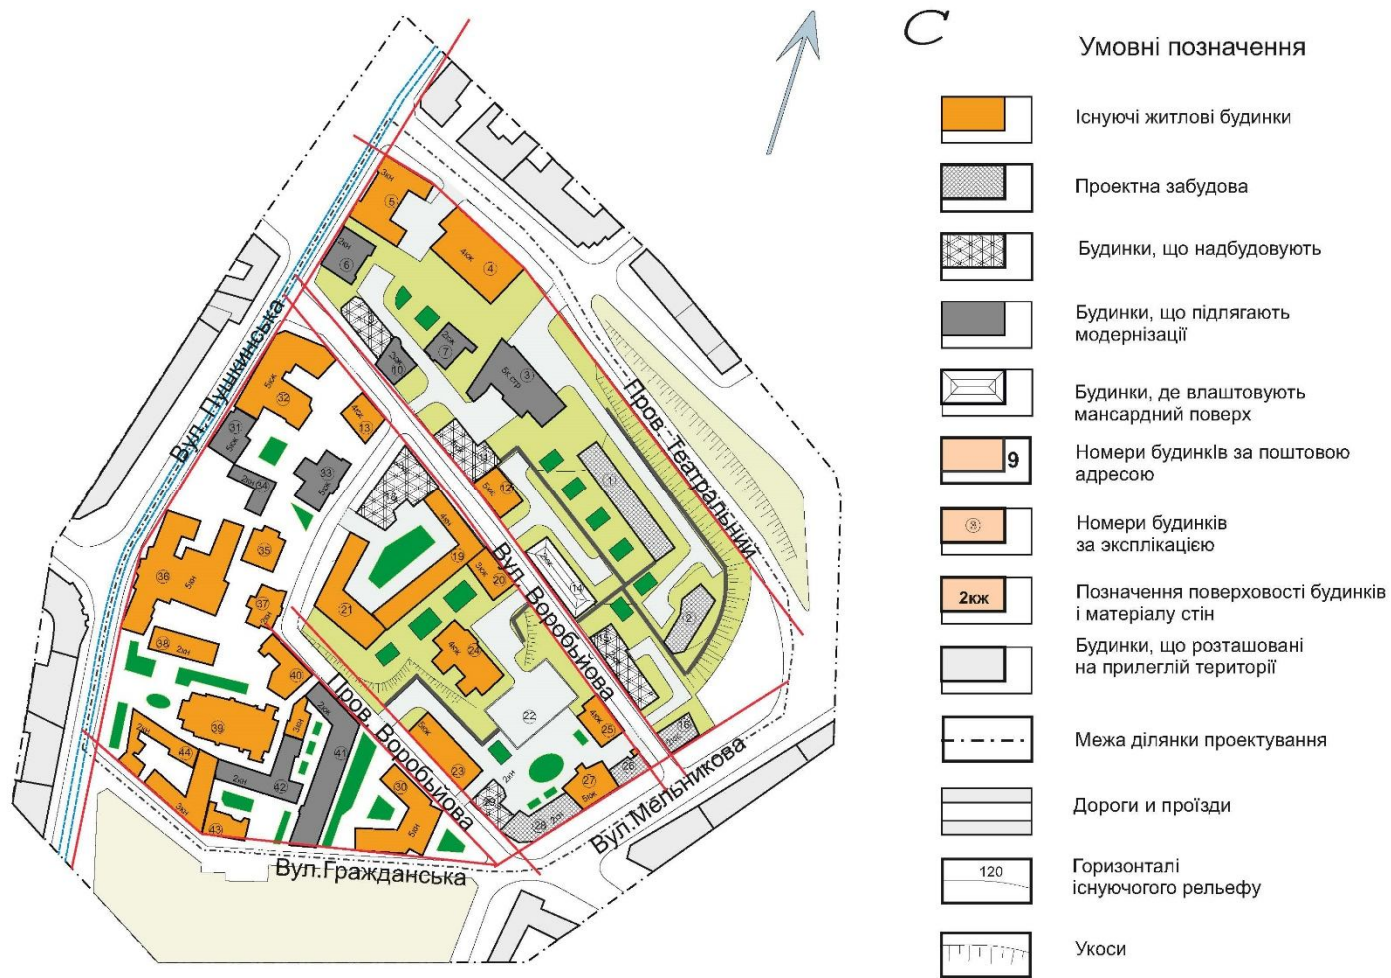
Генеральний план реконструкції кварталу (приклад)
